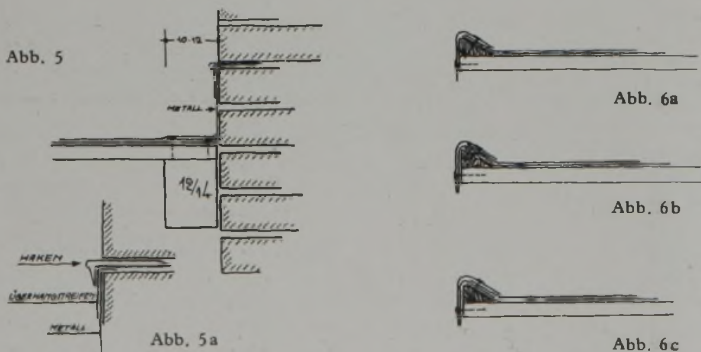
Dachanschluß an eine begrenzende Wand mit Metall-Winkelblech, Ueberhangstreifen mit Fugenkantung und ver-
